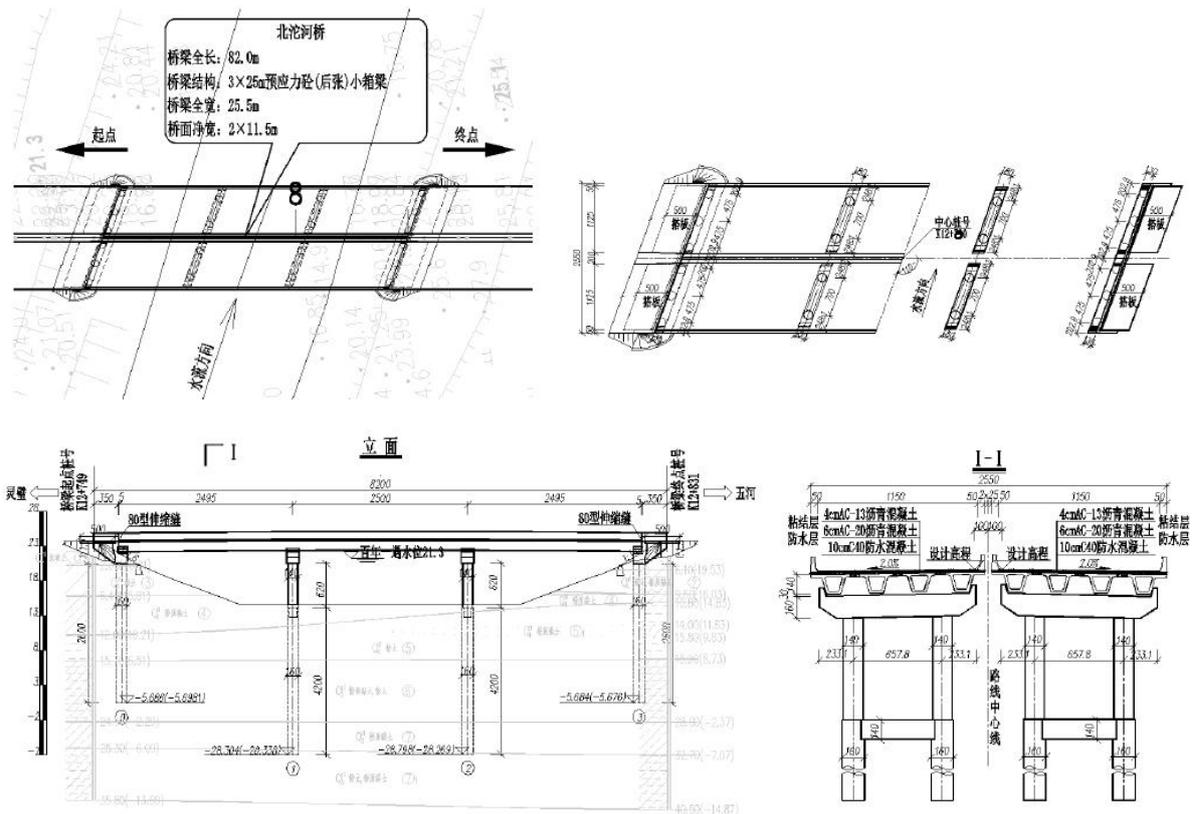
北沱河桥平面图(上图)和拍剖面图(下图)
